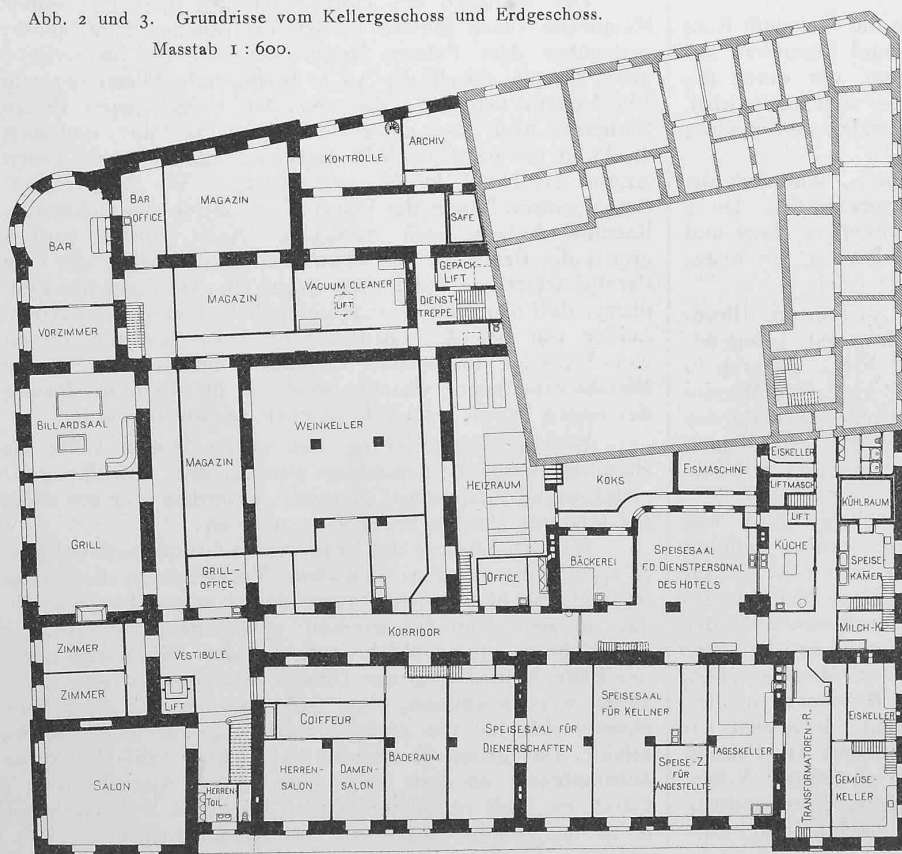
und 3. Grundrisse vom Kellergeschoss und Erdgeschoss.
